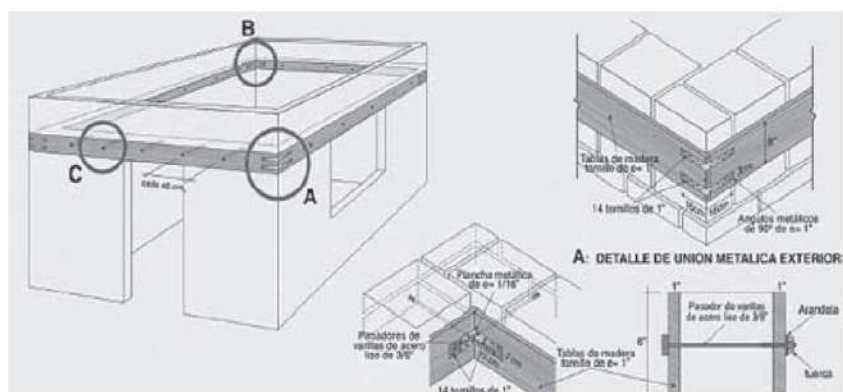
Encadenado de madera colocado en las caras exteriores del muro
